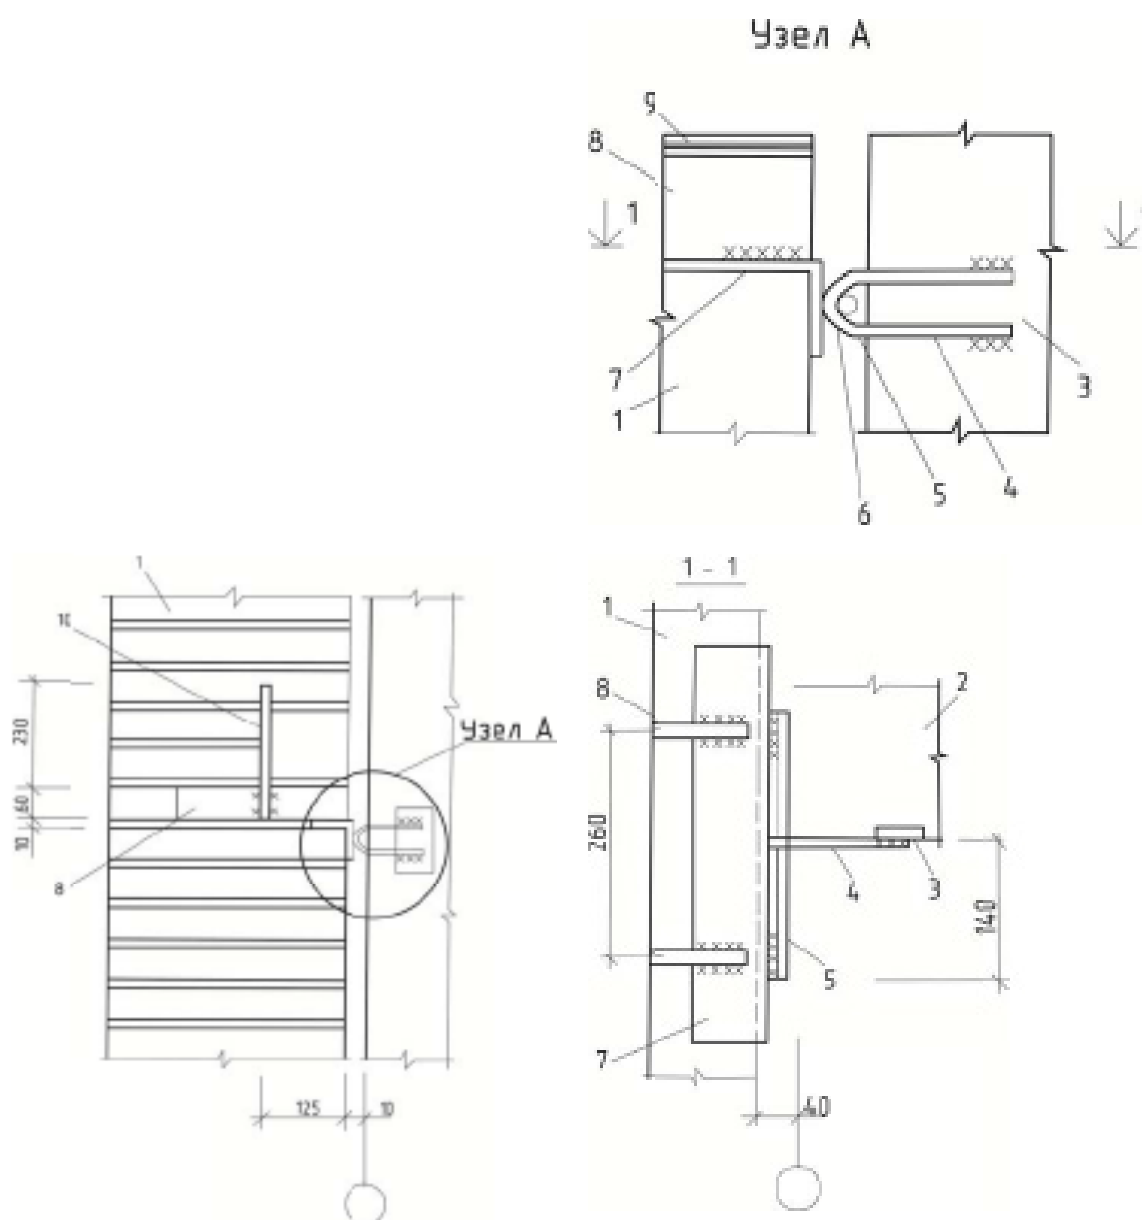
Крепление самонесущей стены к каркасу
